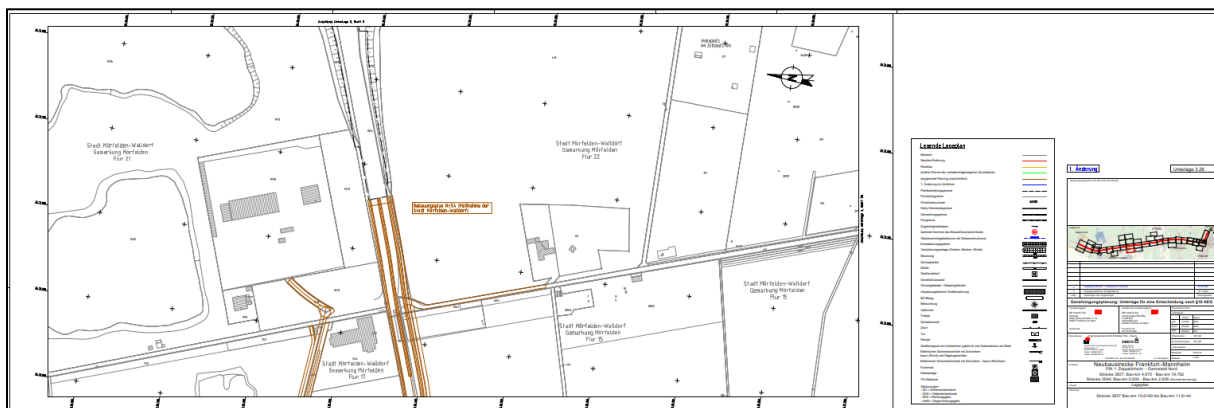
Darstellung des Bebauungsplans Nr. 54 als tangierende Planung im Verfahren
